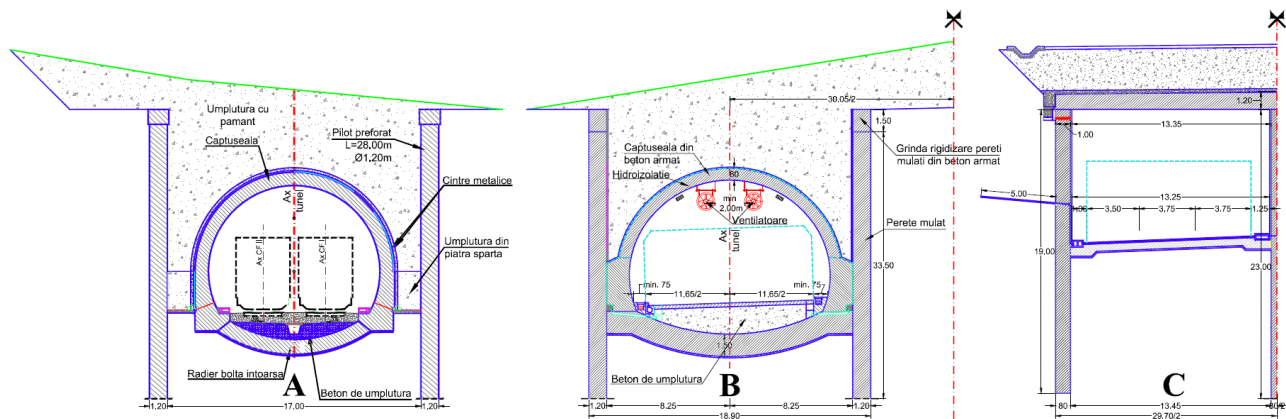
Secțiune transversală tunel: A – Sighișoara^[9], B - Urșilor^[17] - Săcel^[10]
